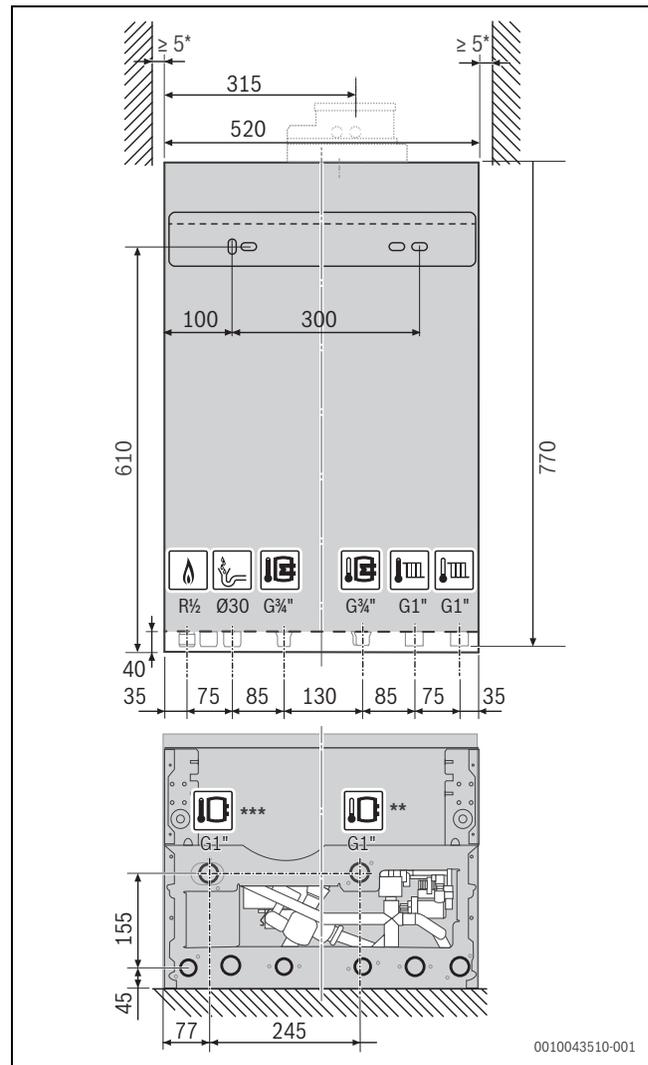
Frontansicht GB(H)192i.2 15-35kW(mm)
